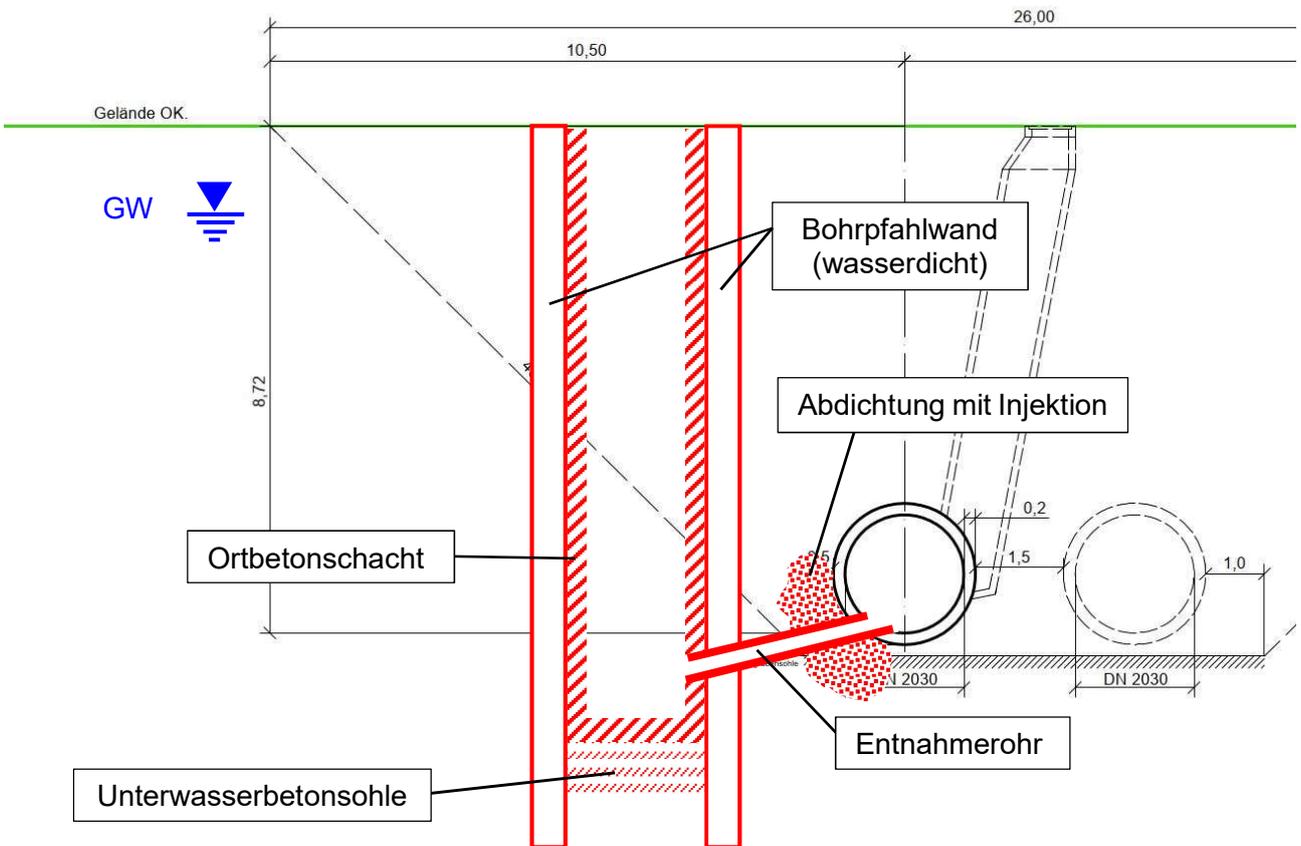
Skizze Ausleitbauwerk (Hintergrund: Plan „Böschung DN 2030 mit Ersatzkanal, Böschungsplan“, Abwasserzweckverband Breisgauer Bucht, 29.01.2021)
